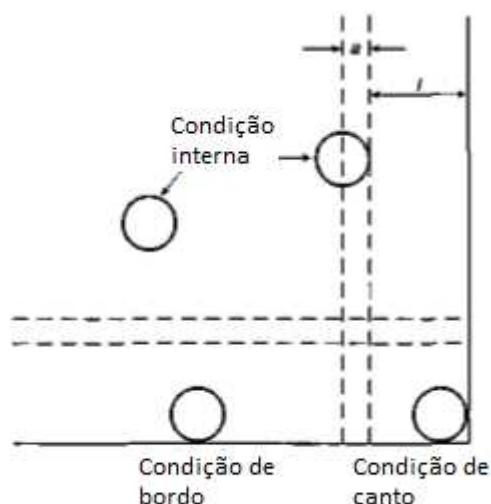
Definição dos locais de carregamento [Adaptado 14]
